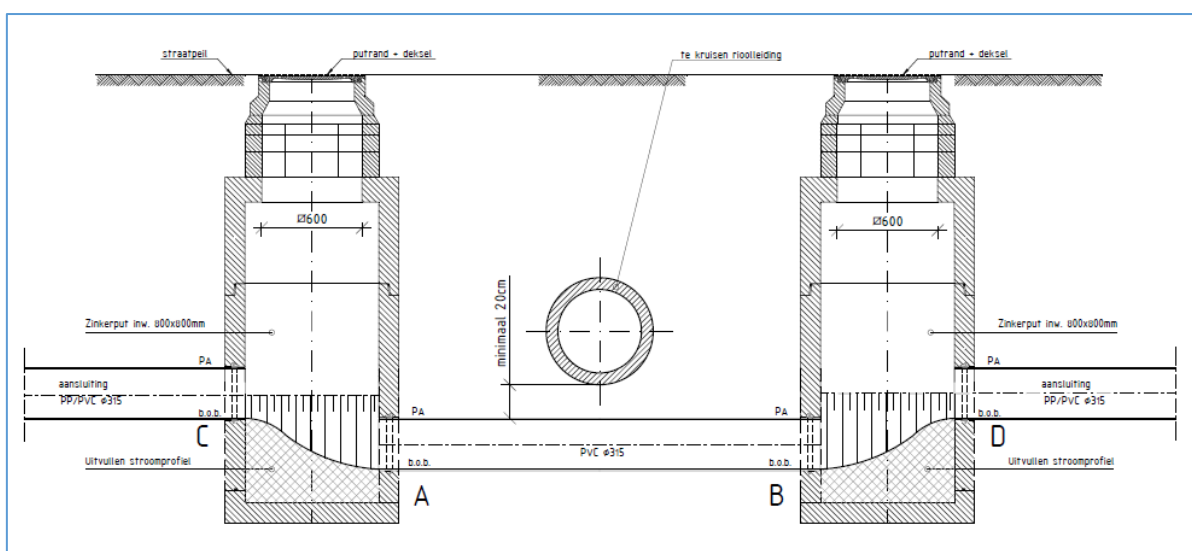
Detail Persleiding riolaansluiting op betonnen riool
